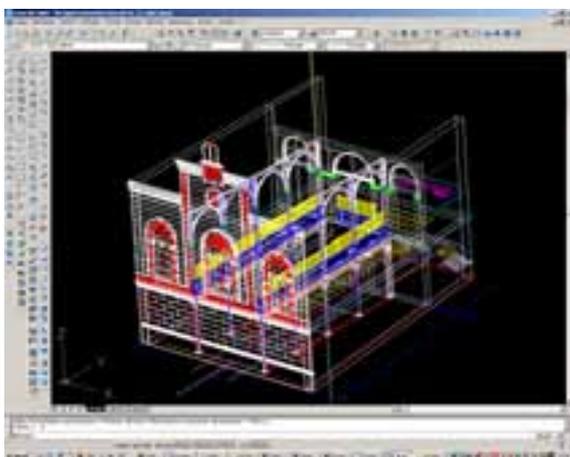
Wände, Tragstruktur und Details in AutoCAD
